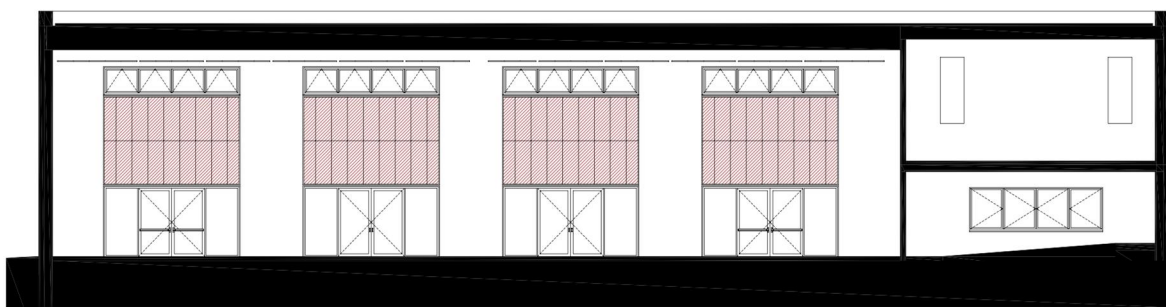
Prospetto Nord con indicazione dei pannelli a parete (pannelli in fibra di legno mineralizzata con retrostante pannello in lana di roccia spess. 75mm)
